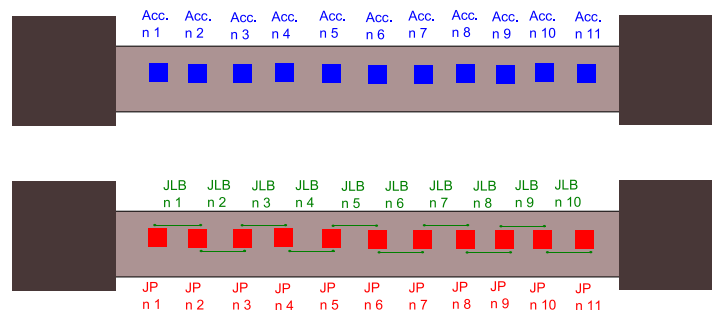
Placement des capteurs sur la poutre E-E
